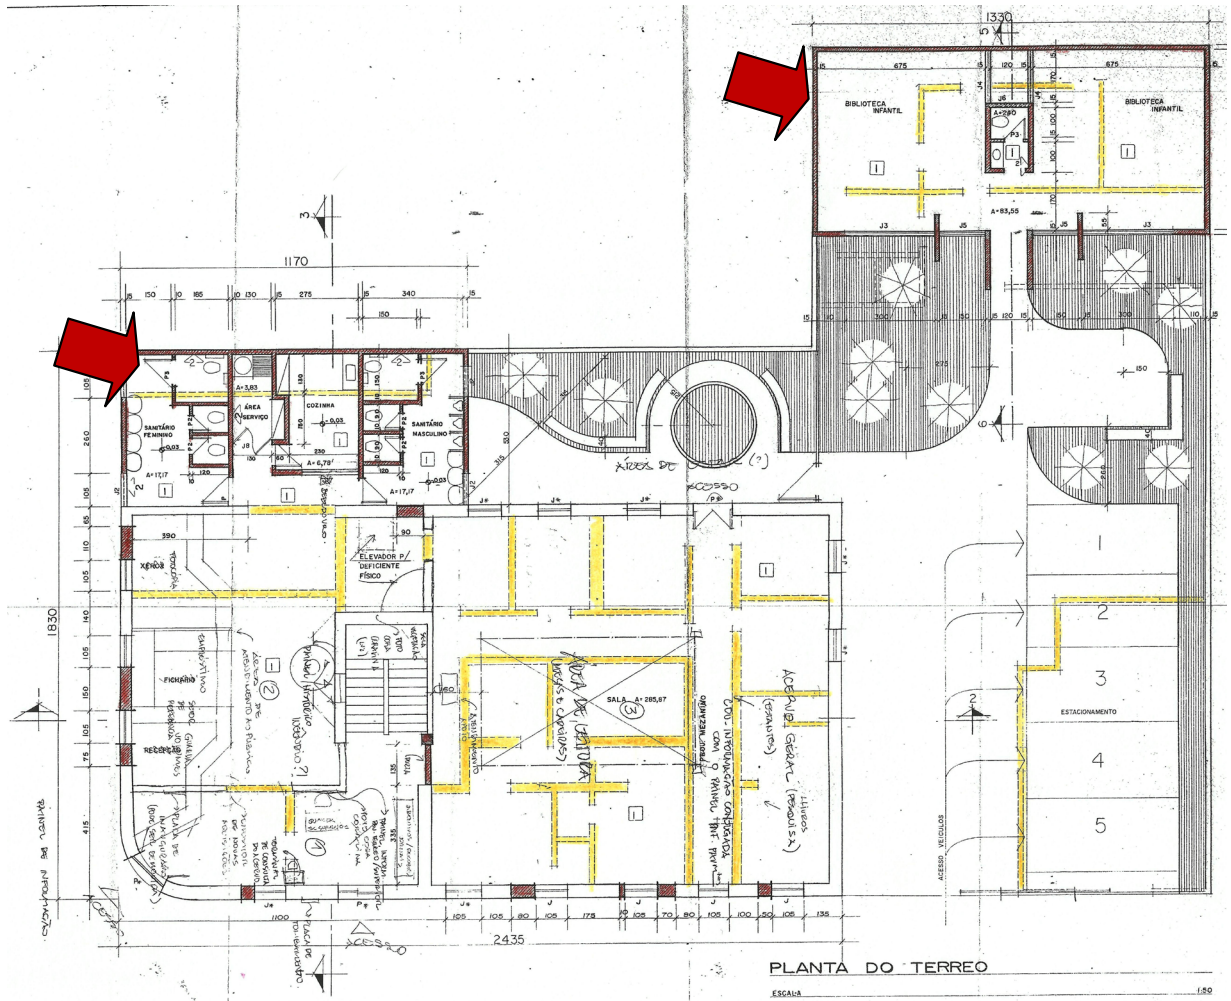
Planta da Reforma do Pavimento Térreo do Palace Hotel de Campinas. Fonte: Arquiteto Nagib Rahime.
